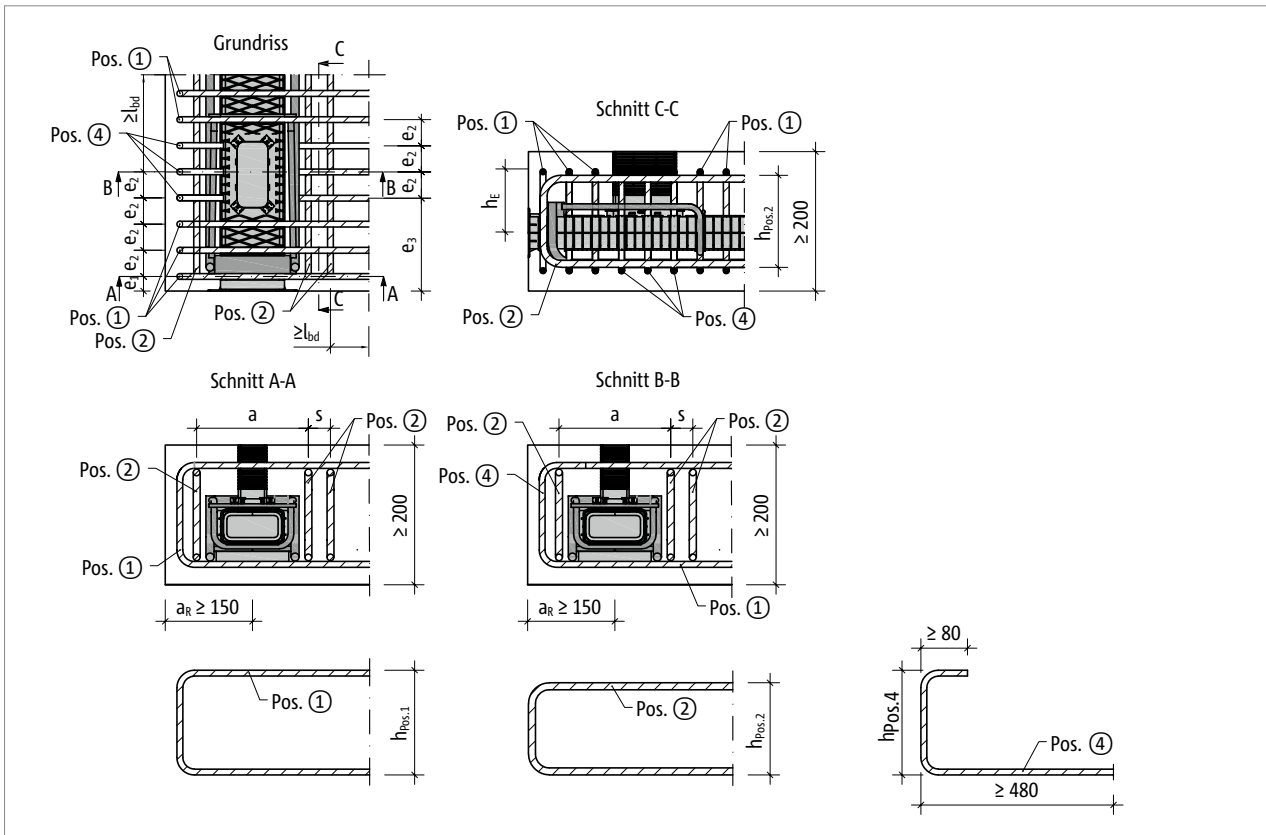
Tronsole® M-O: Bauseitige Bewehrung
